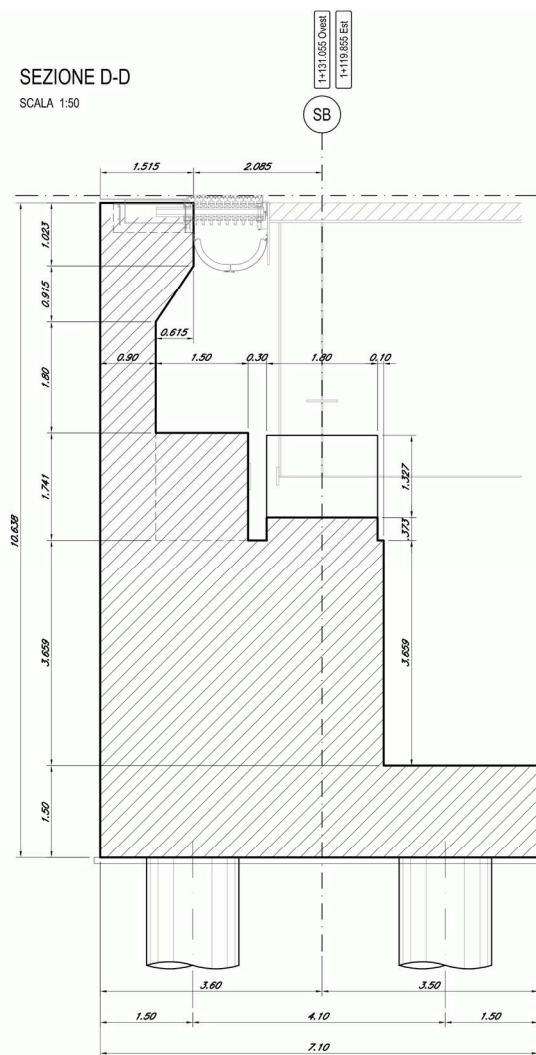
Geometria della spalla – vista laterale e sezione trasversale
